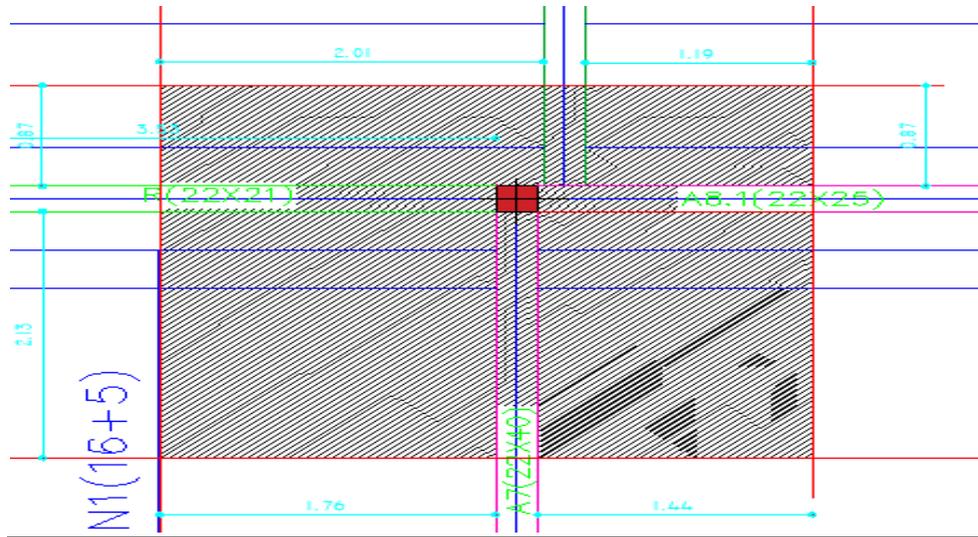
Descente de charge sur le poteau de plancher intermédiaire (RDC)
